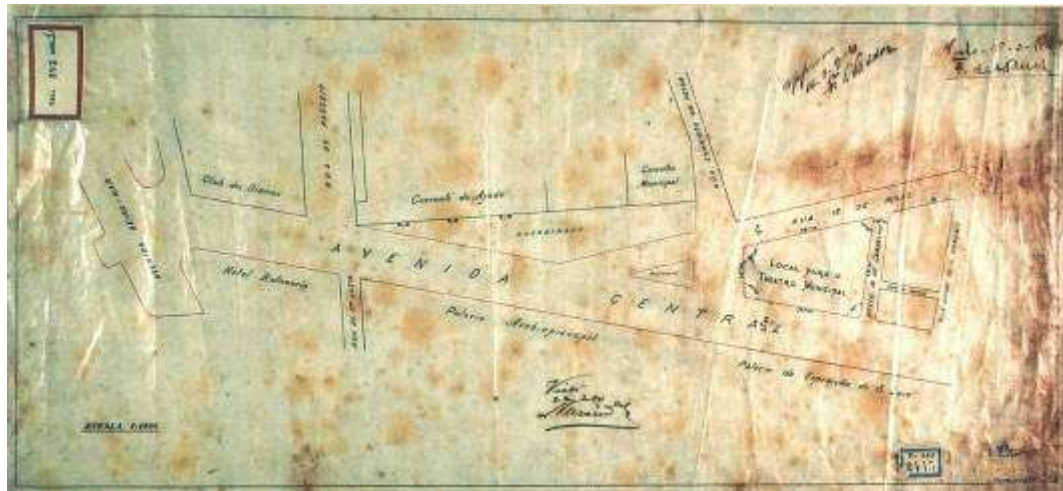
Planta da Avenida Central aprovada por Pereira Passos em 16 de março de 1904, O Palácio São Luiz, futuro Palácio Monroe está locado onde foi construído o Museu Nacional de Belas Artes (Fonte: PINHEIRO, Francisco Pereira Passos vida e obra, 2008)
